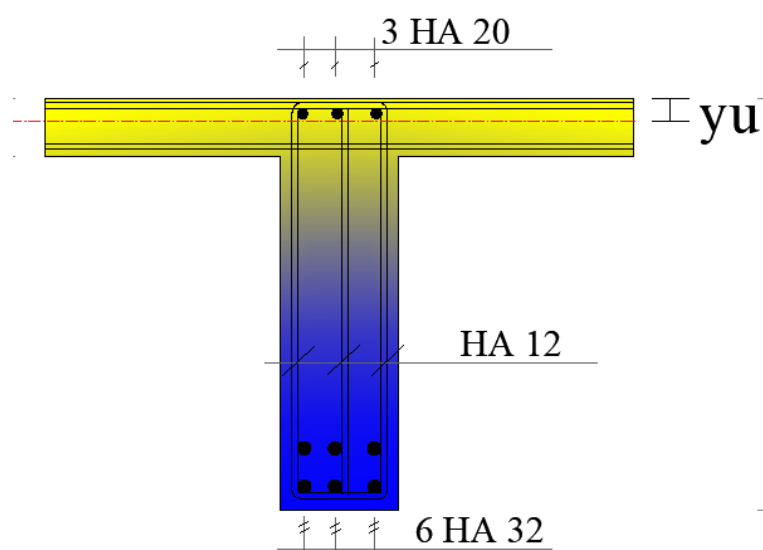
35 - Section en T de la poutre principale avec plan ferrailage (Méthode des poutres droites)
